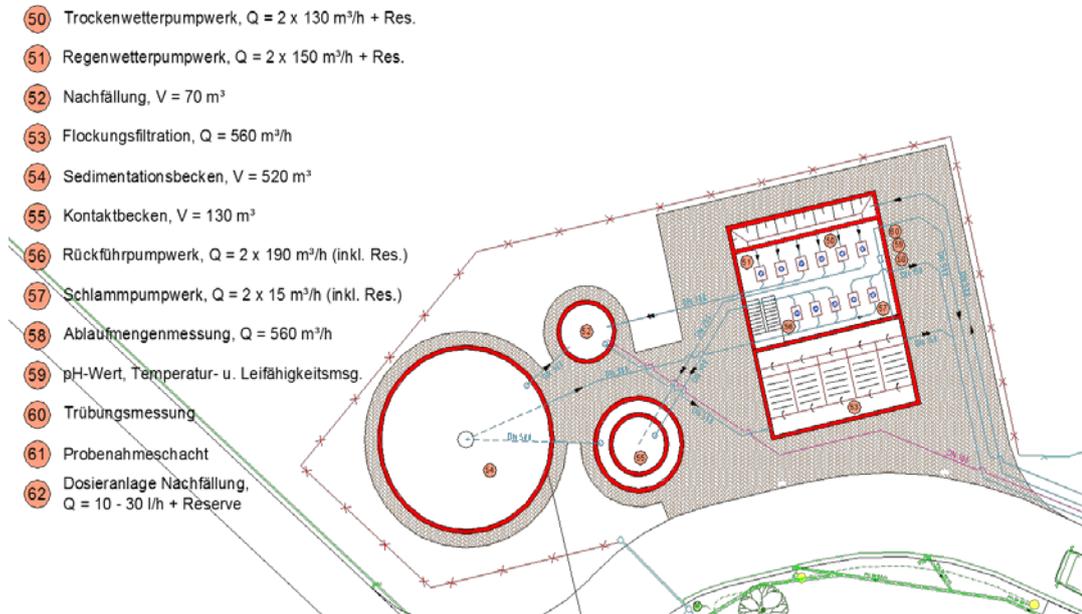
PAK-Dosierung in Kontaktbecken, Lageplan, Ausschnitt
